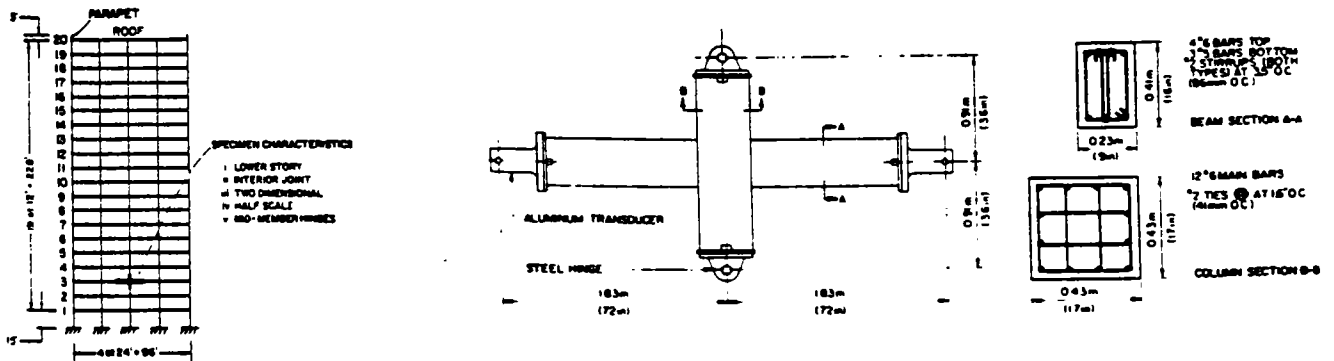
ASSEMBLAGE POUTRE-POTEAU
